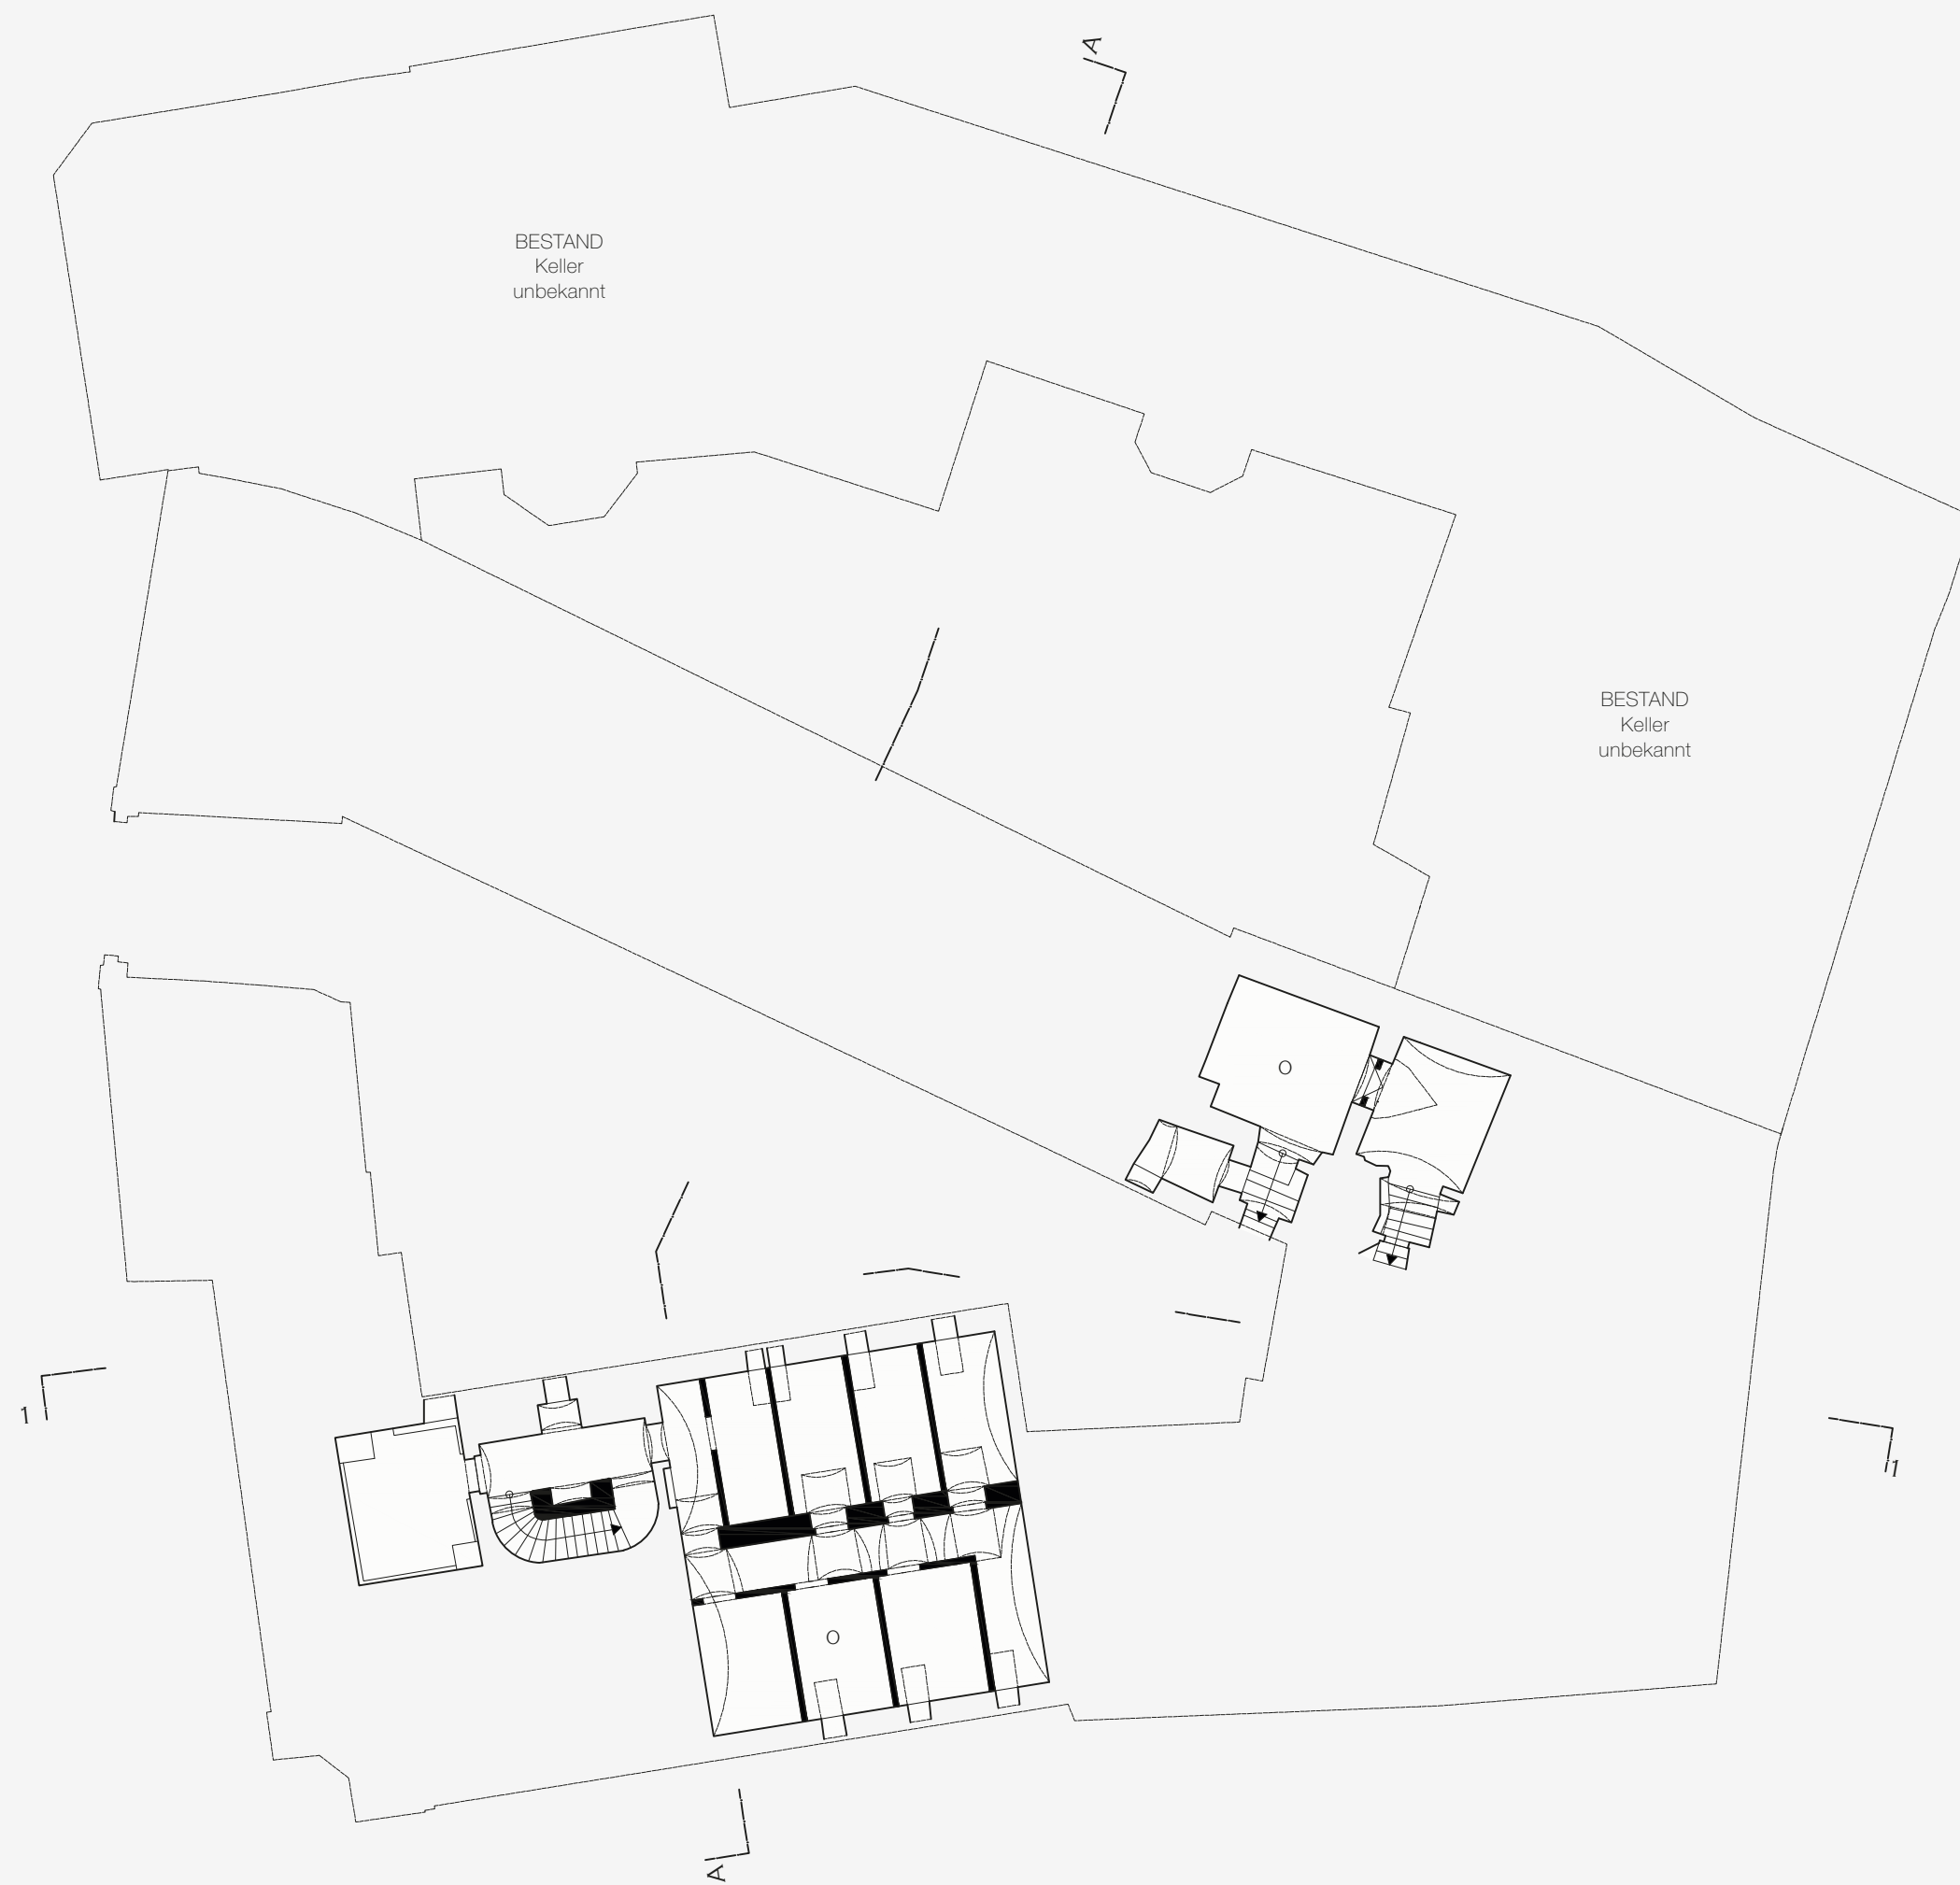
Bestandsplan, Grundriss Untergeschoss
